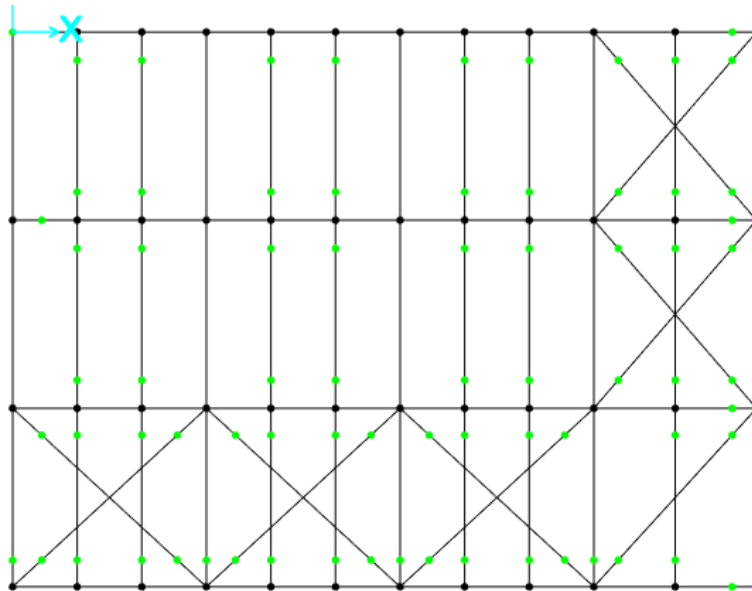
Vista in pianta modello struttura in elevazione – Piano 1 $z = 5,5$ - rilasci
